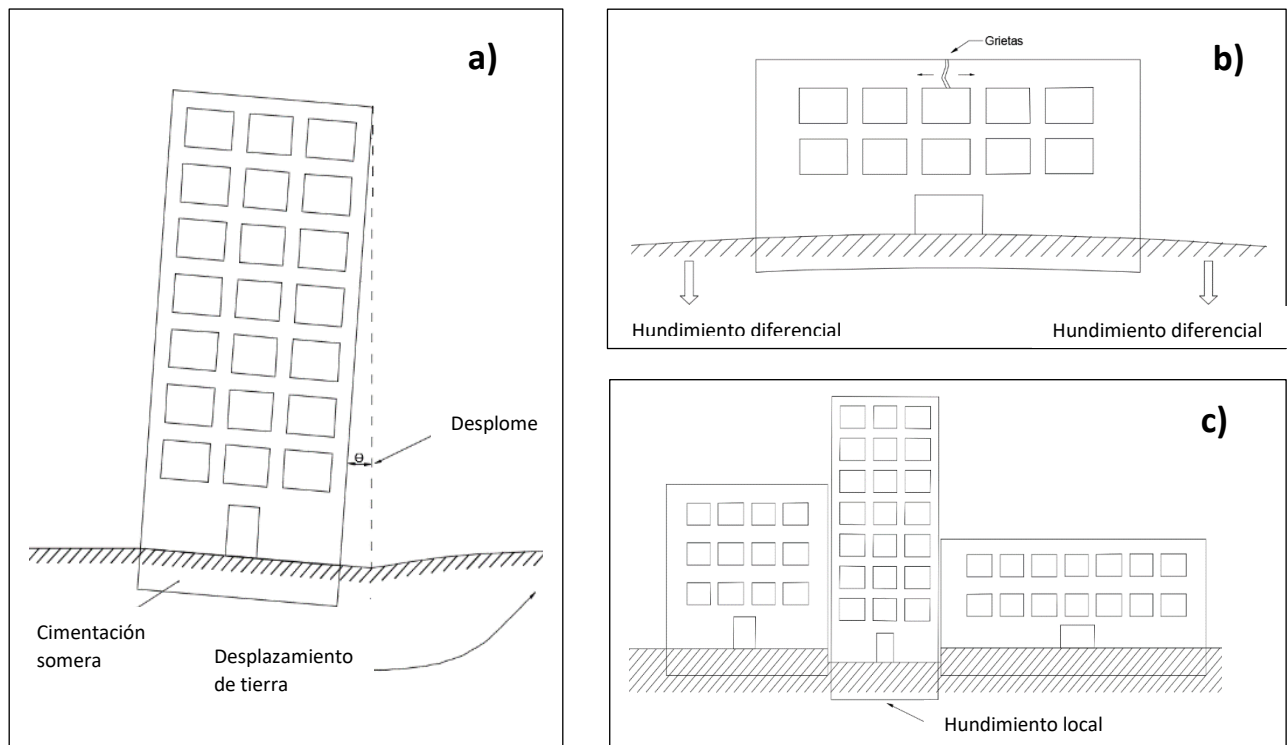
Ilustración de las principales patologías de cimentaciones. a) Desplome. b) Grietas y fisuras. c) Asentamientos
